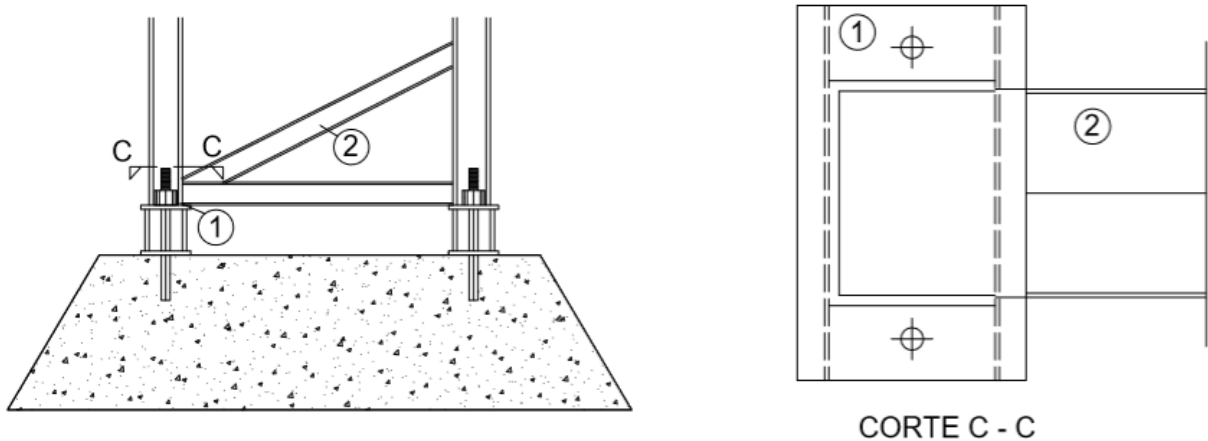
Base para pilares treliçados (De PAULA, 2016)
